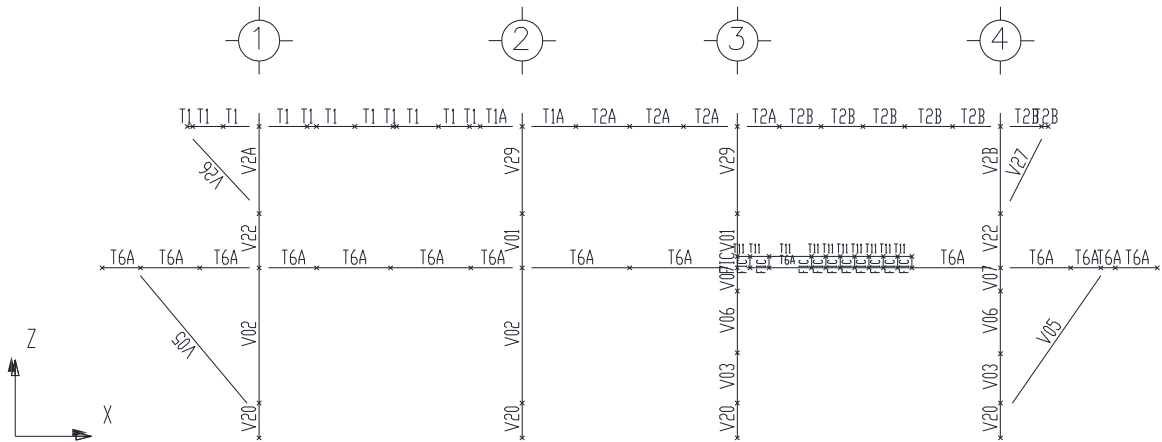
Grupos en marco longitudinal Eje A, superestructura
